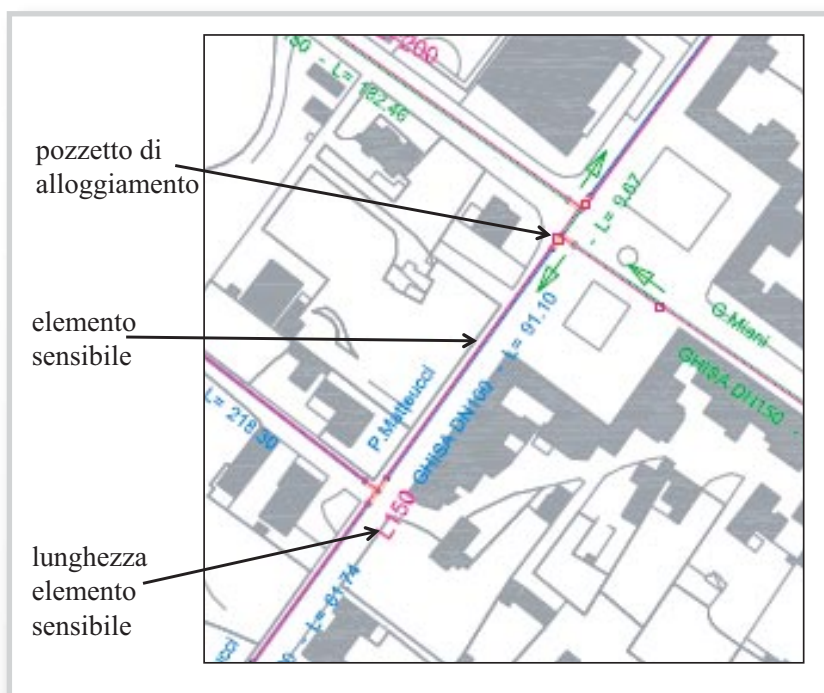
ESEMPIO DI UNO STRALCIO DI PLANIMETRIA PROGETTUALE PER LA PREDISPOSIZIONE DEL SISTEMA S.I.M.P.Le.
